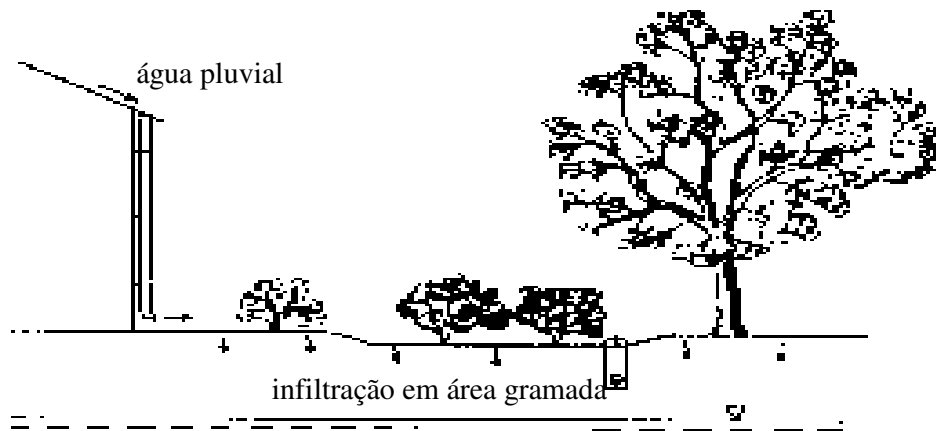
Plano de infiltração (Urbonas e Stahre, 1993).
